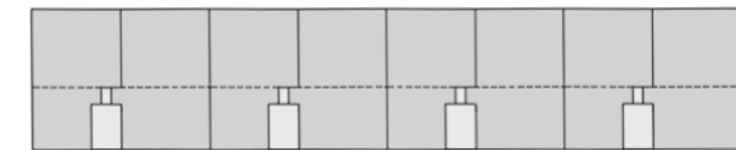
Esquema planta primera y tercera. Fuente: Elaboración propia
